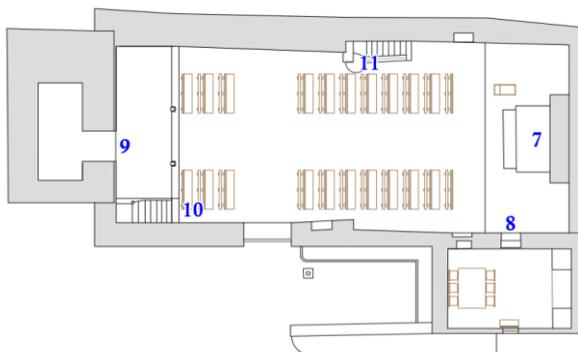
Esquema descriptivo zonas planta baja. Fuente propia, 2018.
